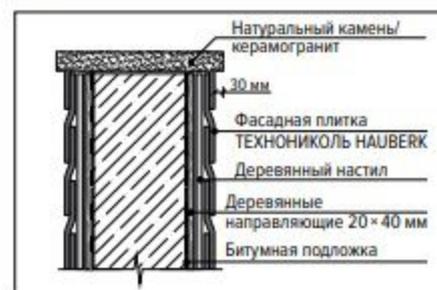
Монтаж фасадной плитки на подпорную стенку. Вариант 1
